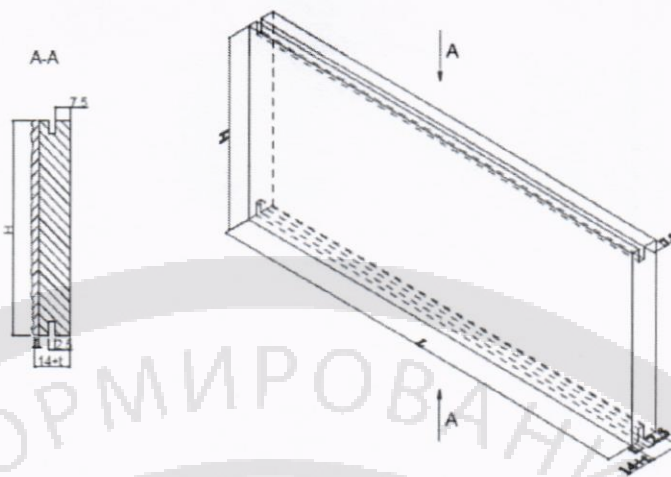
Общий вид и профиль поперечного сечения плитки «King Stone», тип А (с монтажным пазом)
